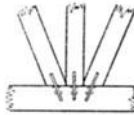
Druckstoß mit kleinen Zapfen und Bankklammern.
